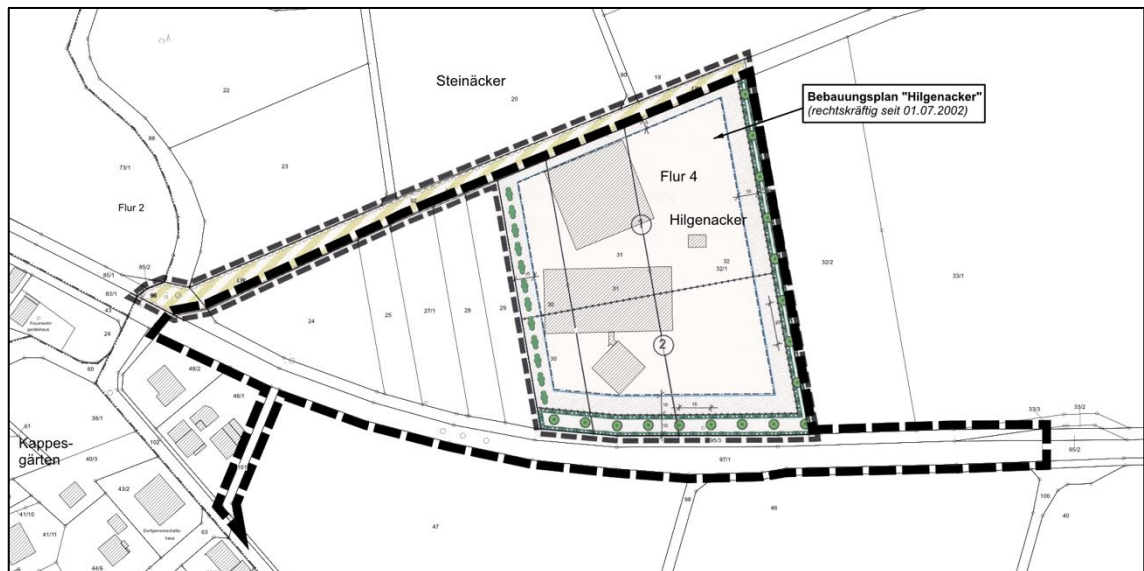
Plangebiet und Ursprungsbebauungsplan
